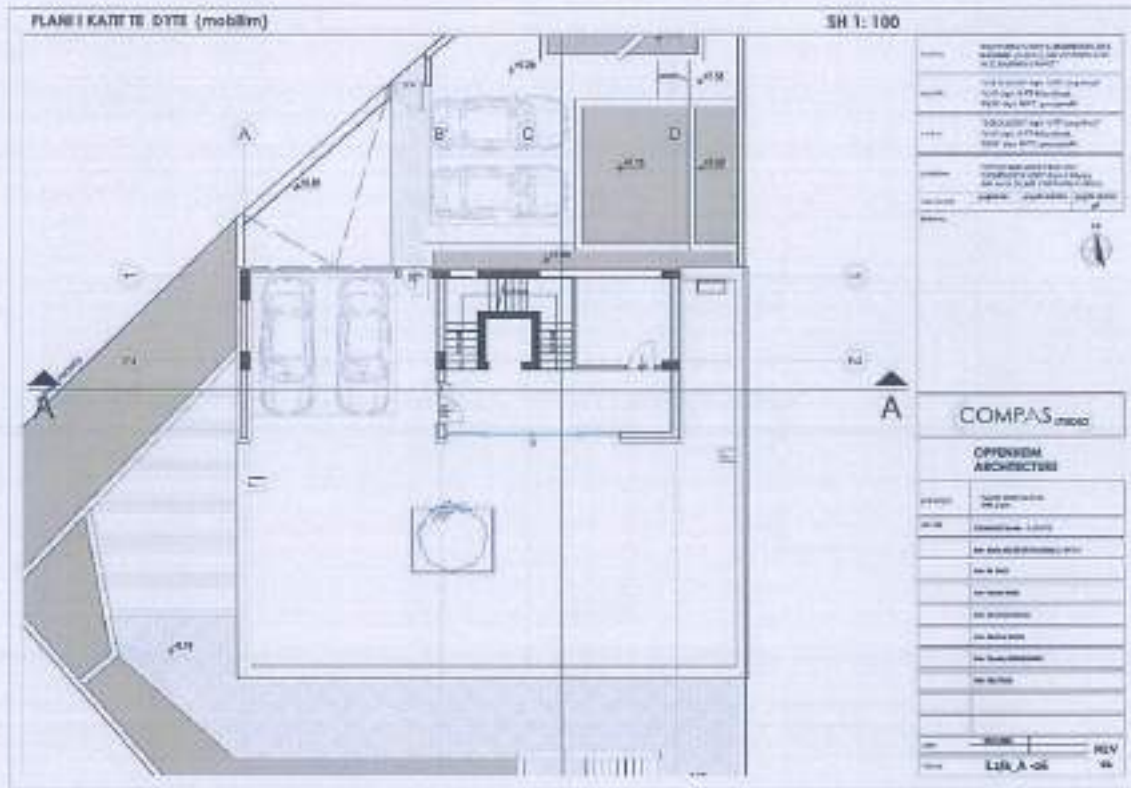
Vila L2-a \_Planimetria e kati të dytë
